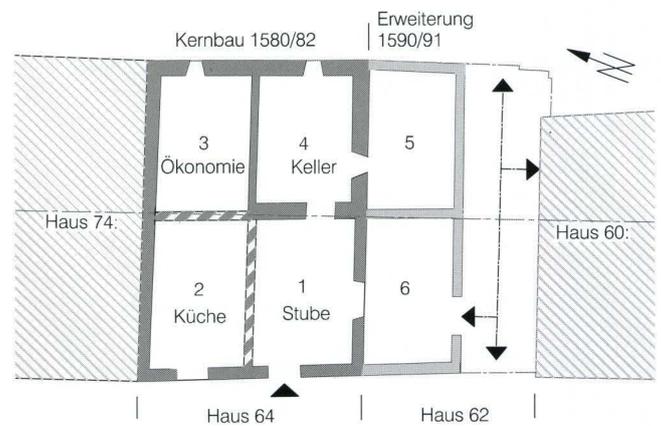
Obere Dorfstrasse 62/64. Grundriss mit Rekonstruktion. – Zeichnung: Hans Ritzmann.
